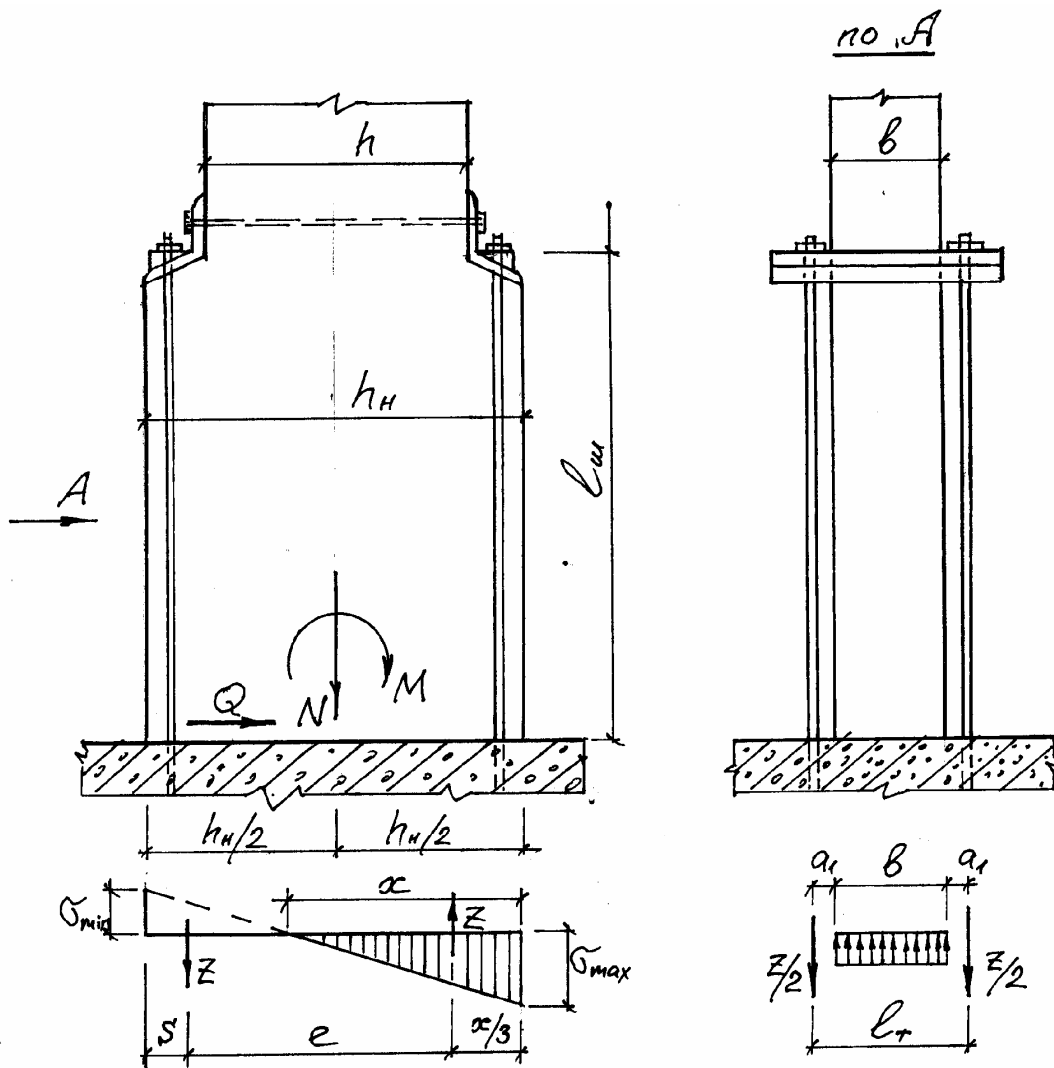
До розрахунку кріплення стояка до фундаменту
